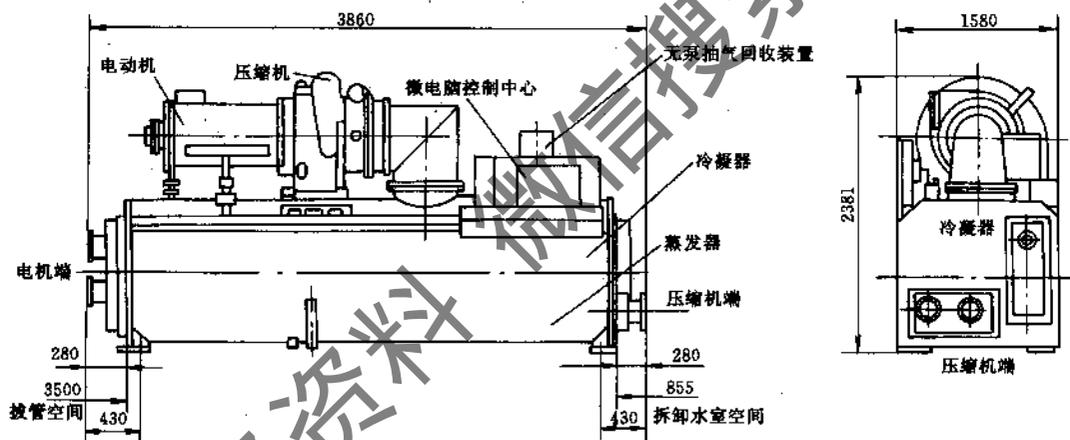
LSBLXR 系列 700/900/1050 型离心式冷水机组外形尺寸图
